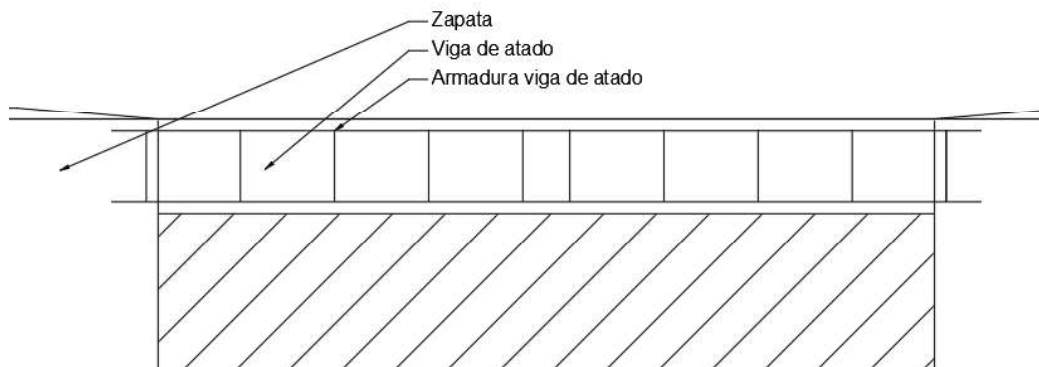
Esquema de una viga de atado entre dos zapatas.
